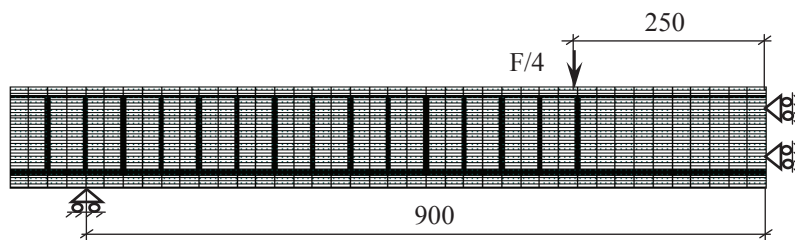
Схема навантаження SE моделі залізобетонної балки
